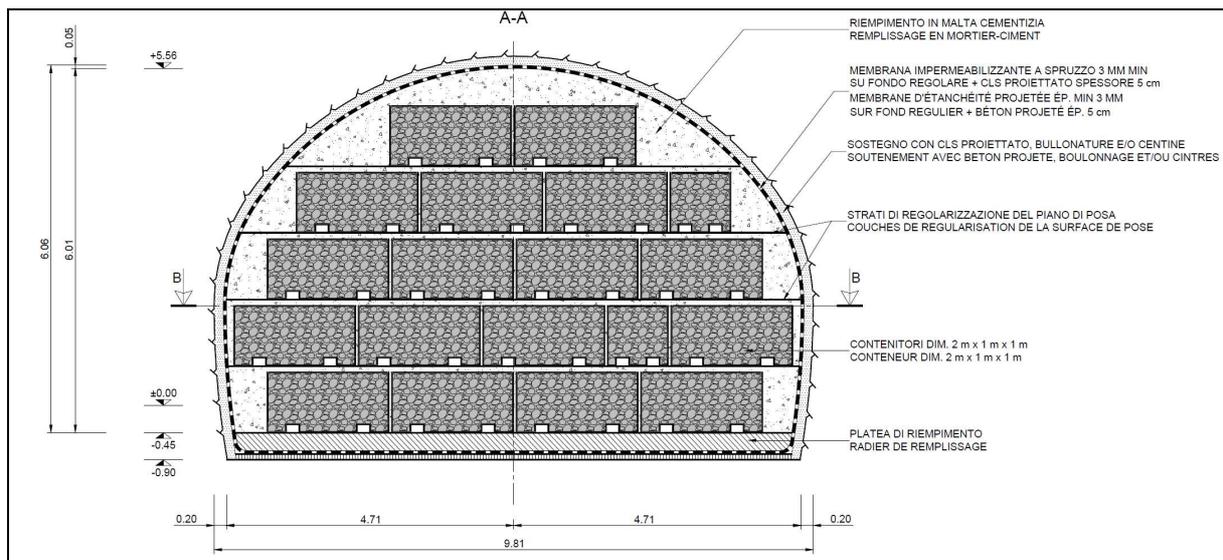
Sezione di stoccaggio nella sezione corrente di Maddalena Ibis
